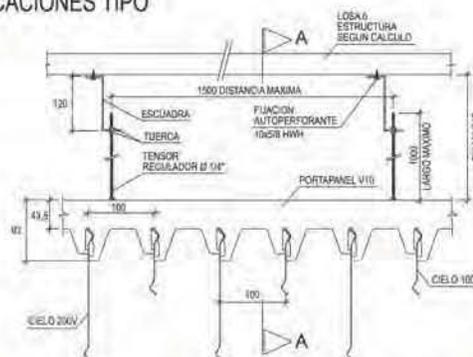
Corte transversal donde se muestra la instalación del plafón en la estructura.
